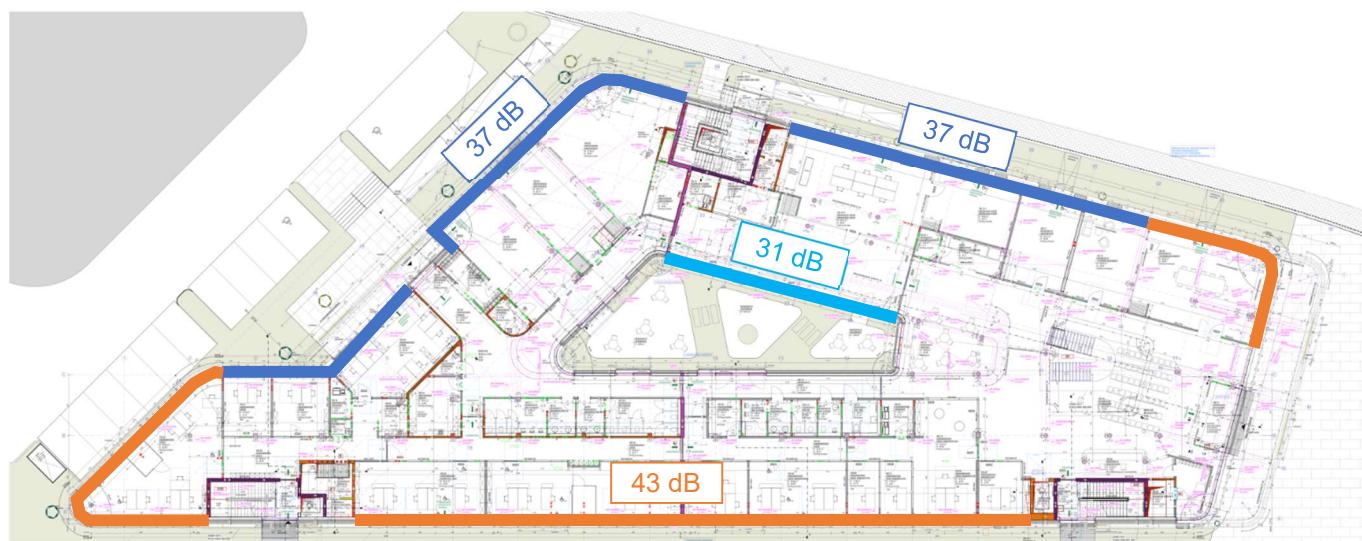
mögliche Fassadenabschnitte mit gleichen Fensterqualitäten von schutzbedürftigen Räumen im Erdgeschoss (Schalldämm-Maße angepasst)
